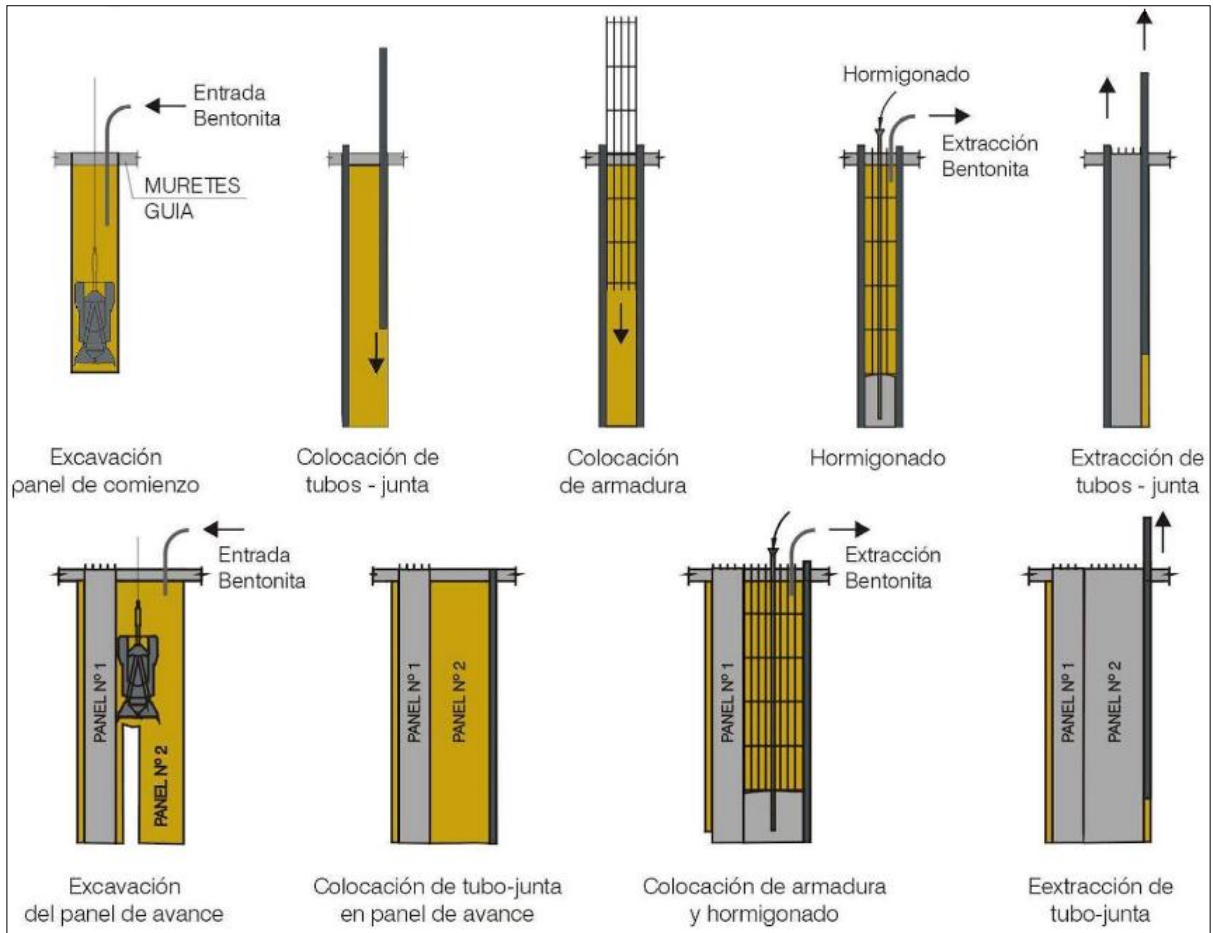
Proceso Constructivo de Muro Pantalla
